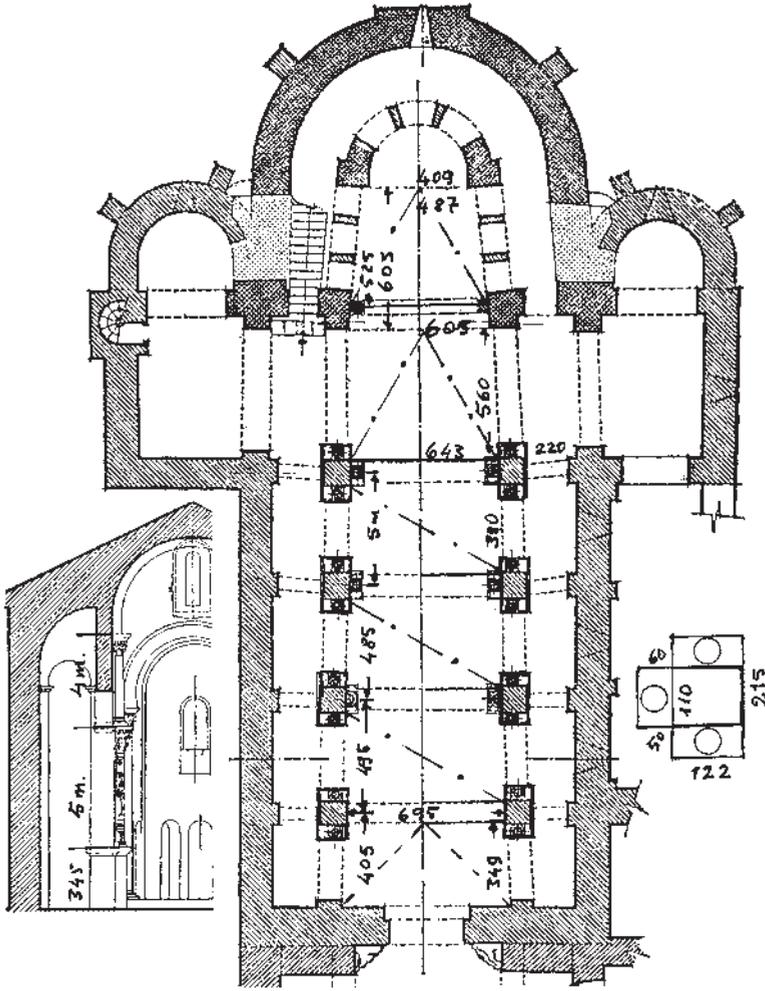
Sant Pere de Rodés, medidas y esquema de los espacios sobre la planta y alzado de F. Inñiguez; detalle de un pilar.
